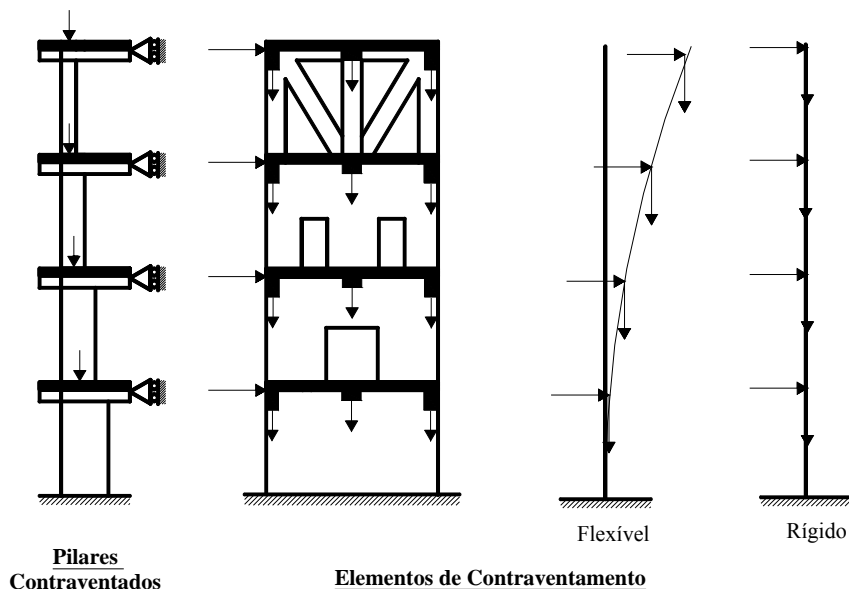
Pilares contraventados e elementos de contraventamento (FUSCO, 1981).
